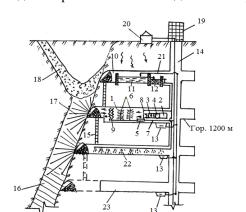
Схема размещения оборудования форсуночного воздушно-водоиспарительного охлаждения рудничного воздуха с использованием шахтных вод:1-камера форсуночного охлаждения; 2-вентилятор; 3-нагреватель; 4- гибкий рукав; 5- охлаждающий эжектор; 6 - форсунки; 7,8 - трубопроводы для сжатого воздуха и шахтной воды; 9 - конденсатор; 10 - отработанная выработка; 11-основной водоем; 12 - песчаный фильтр; 13 - вспомогательный водоем; 14 - главный воздухоподающий ствол; 15 - восстающий; 16 - рудная залежь; 17-скважины; 18 - обрушенные породы; 19 - надшахтное здание; 20 - компрессорная станция; 21 - трубопровод для перекачки шахтной воды; 22 - водовоздушные завесы; 23 - квершлаг проходки
